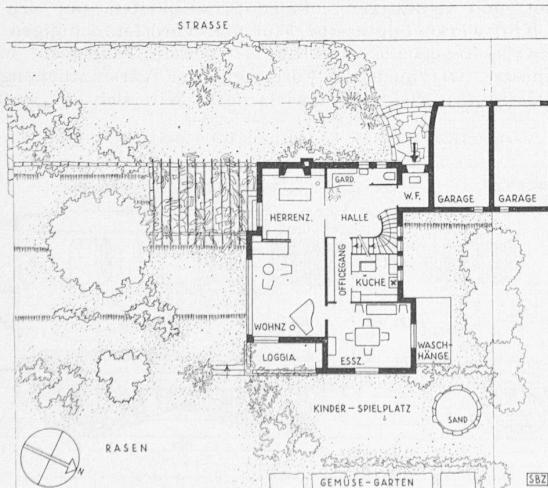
bis 7. Landhaus in Kilchberg, Grundrisse und Schnitt 1:400
